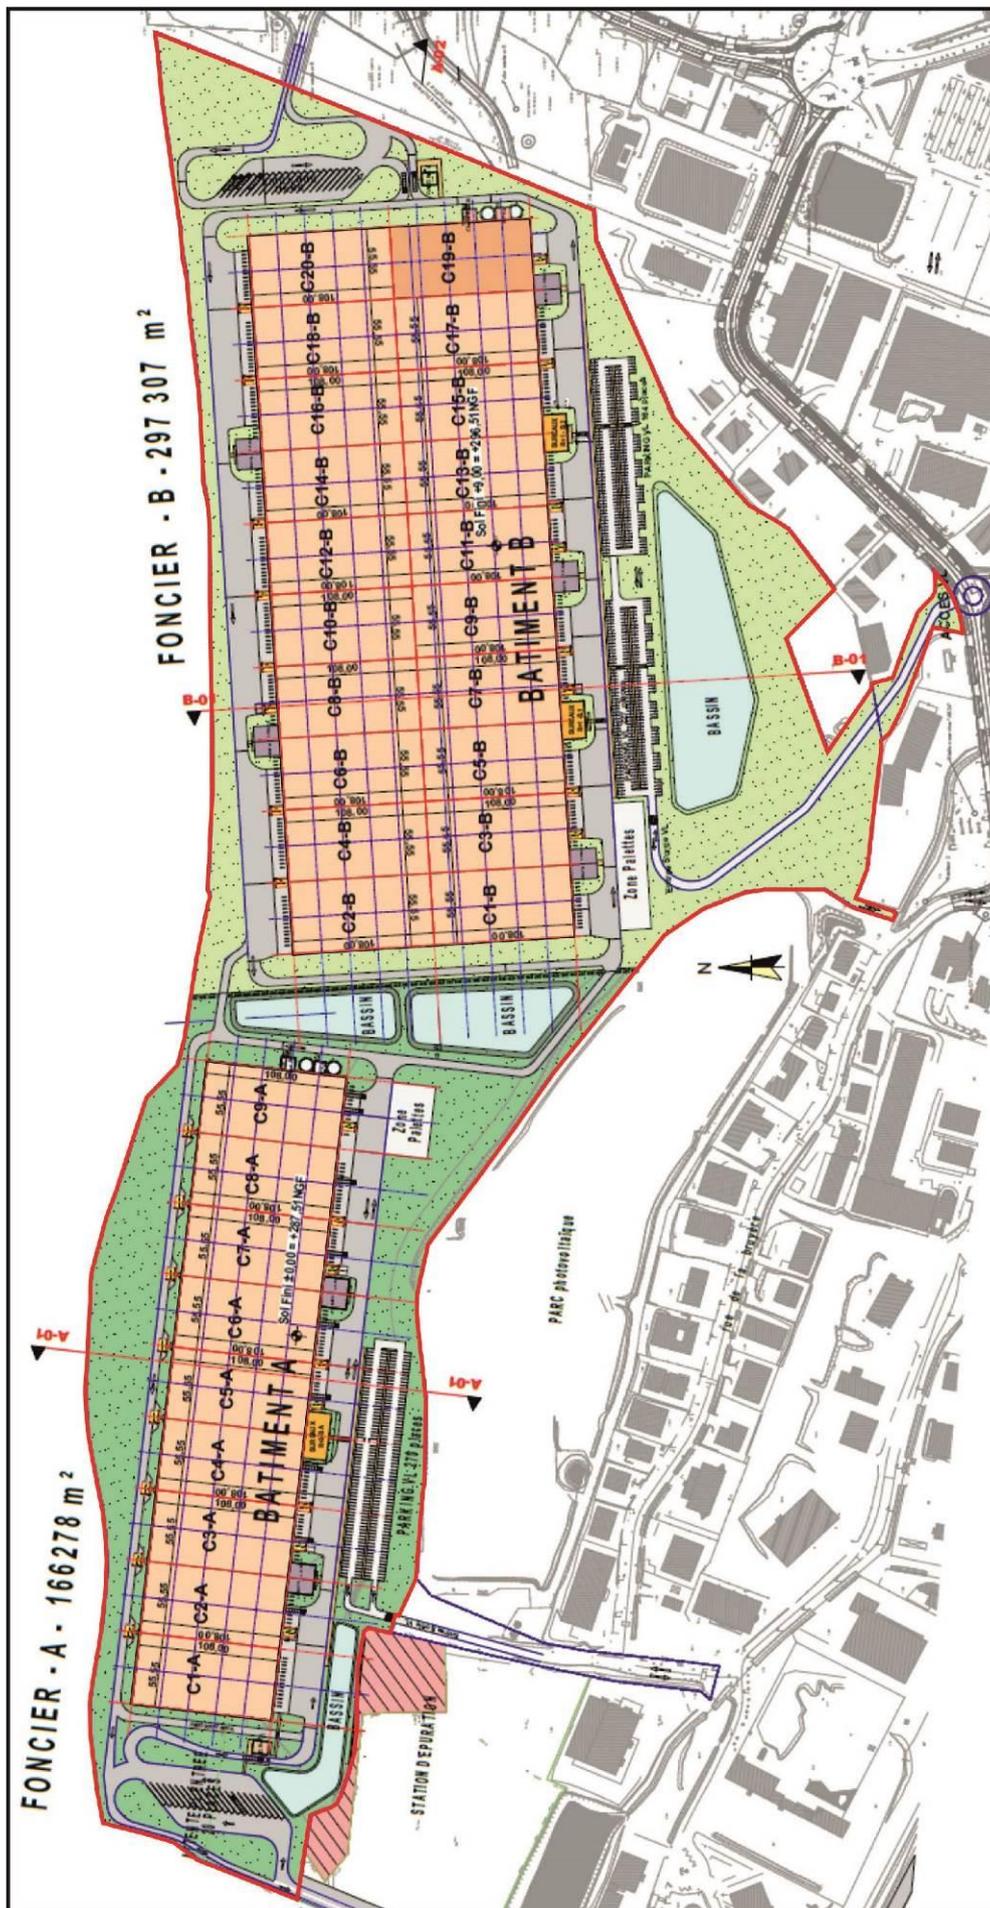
Extrait du plan d'implantation des fonciers, à l'échelle 1/5 000
